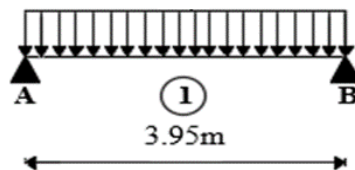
Schéma du 3^{ème} type de poutrelles
